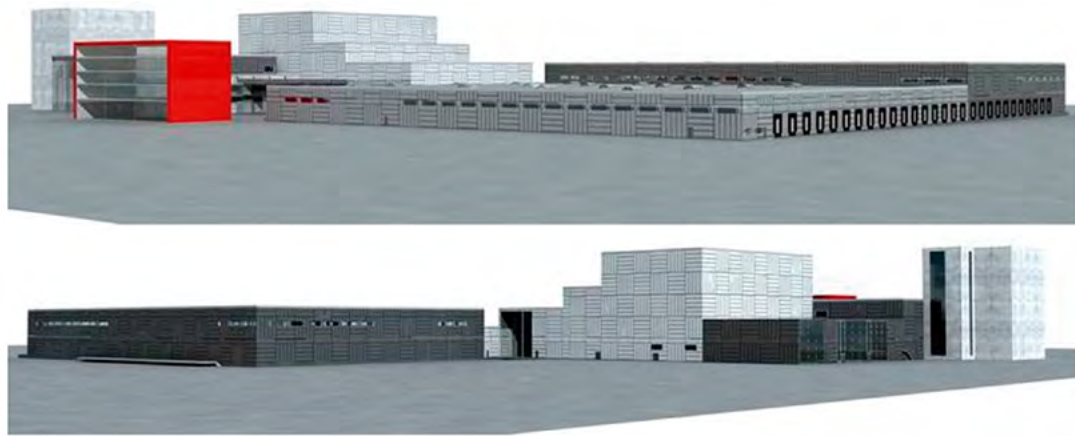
Фрагмент фасада производственного здания с применением трехслойных стеновых панелей горизонтальной разрезки
